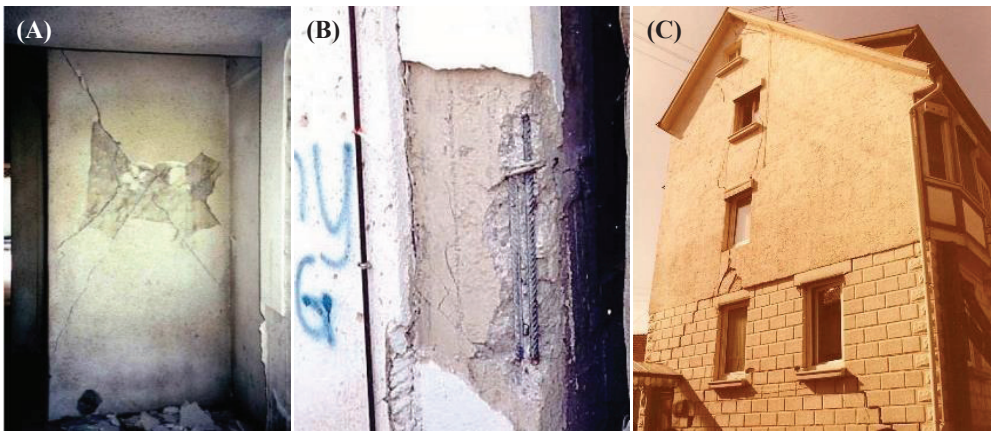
Beispielfotos *mäßiger* Schäden – Stahlbeton (A, B) [5] und Mauerwerk (C) [55]
